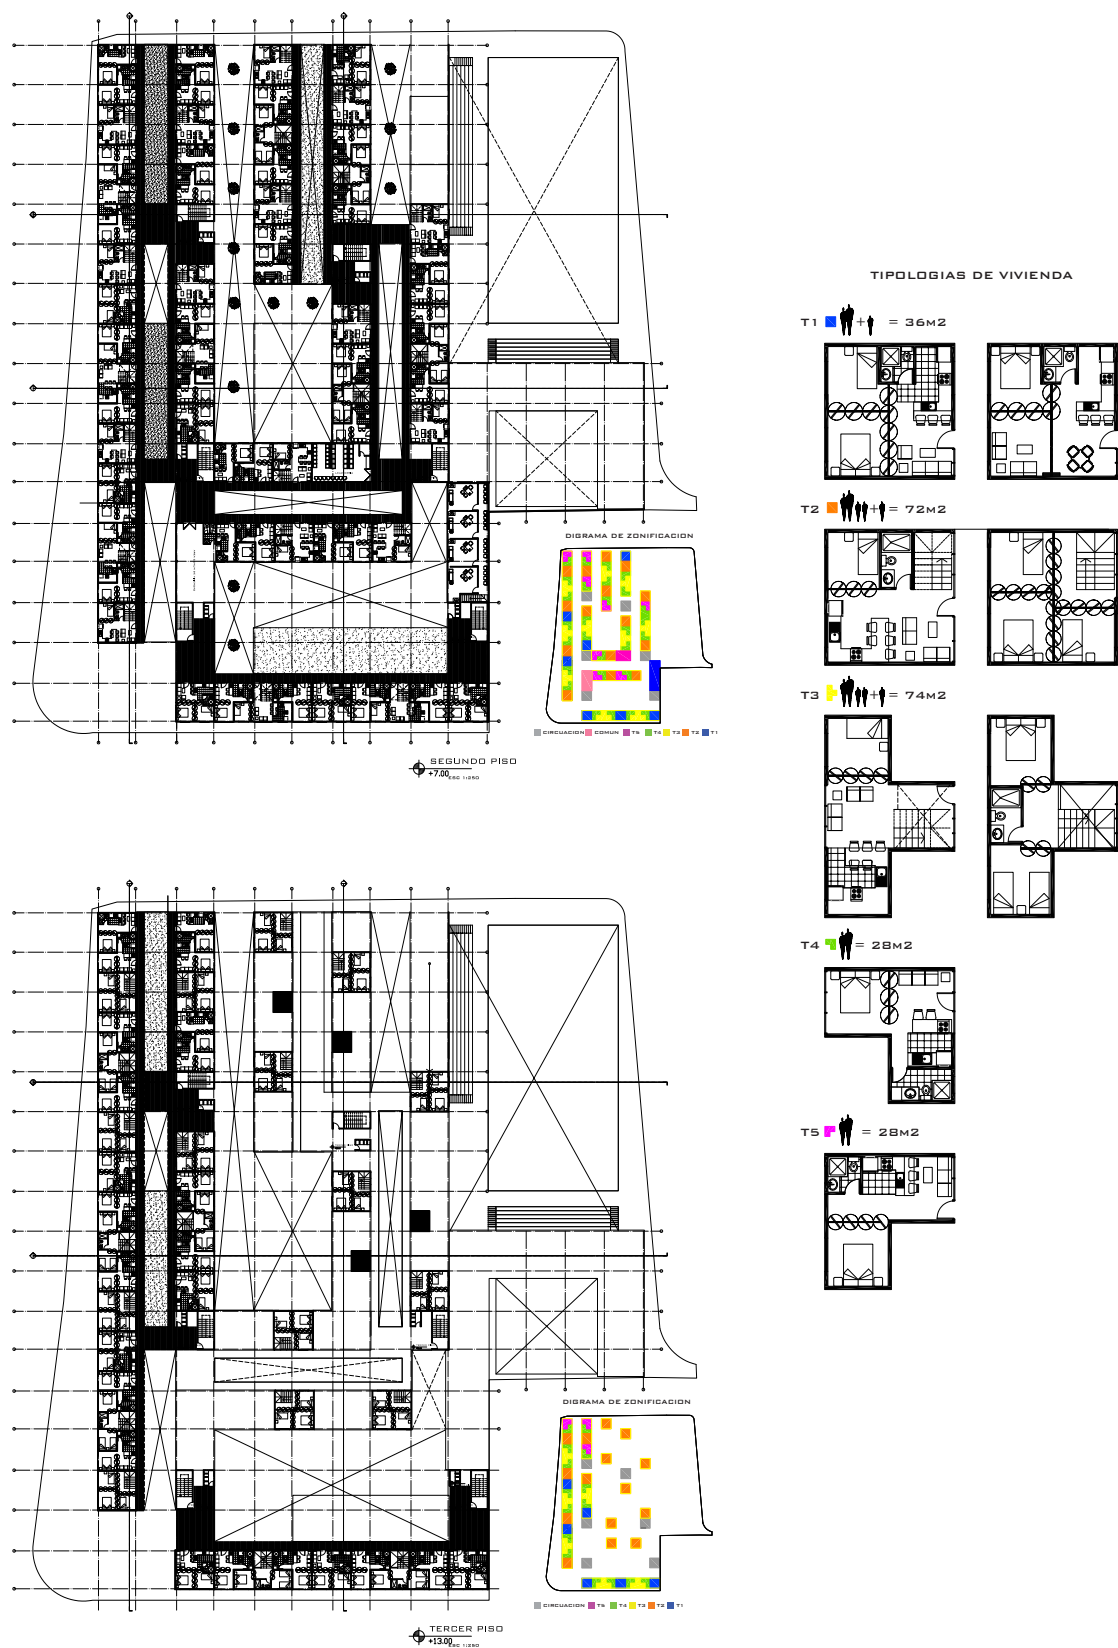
Segundo, tercer piso y tipologías de vivienda del proyecto arquitectónico
